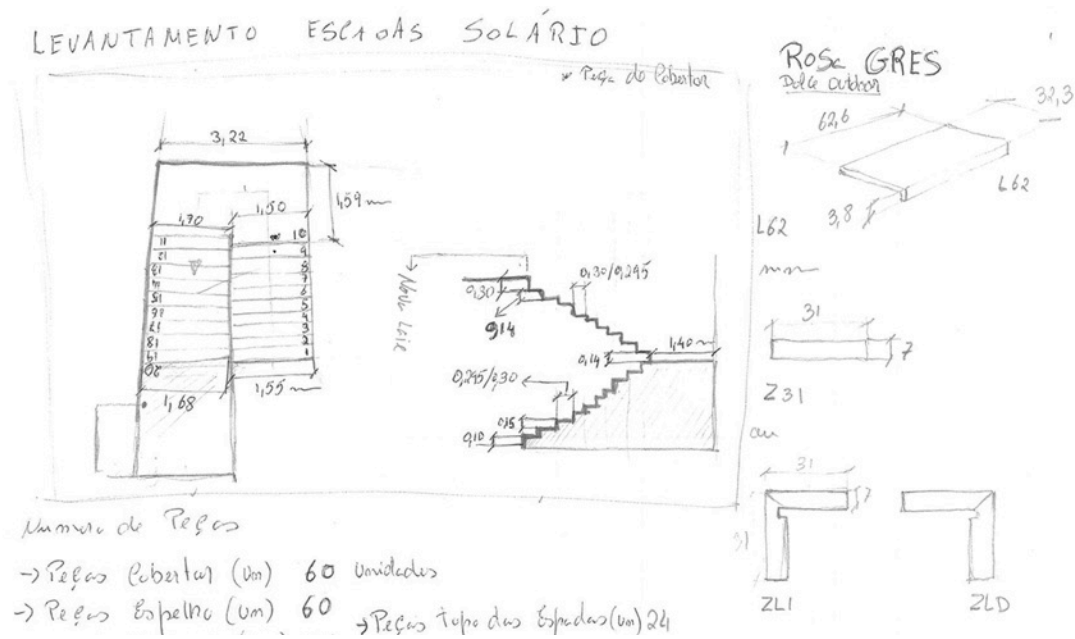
Levantamento da escadaria de acesso ao solário, para a aplicação de pavimento
